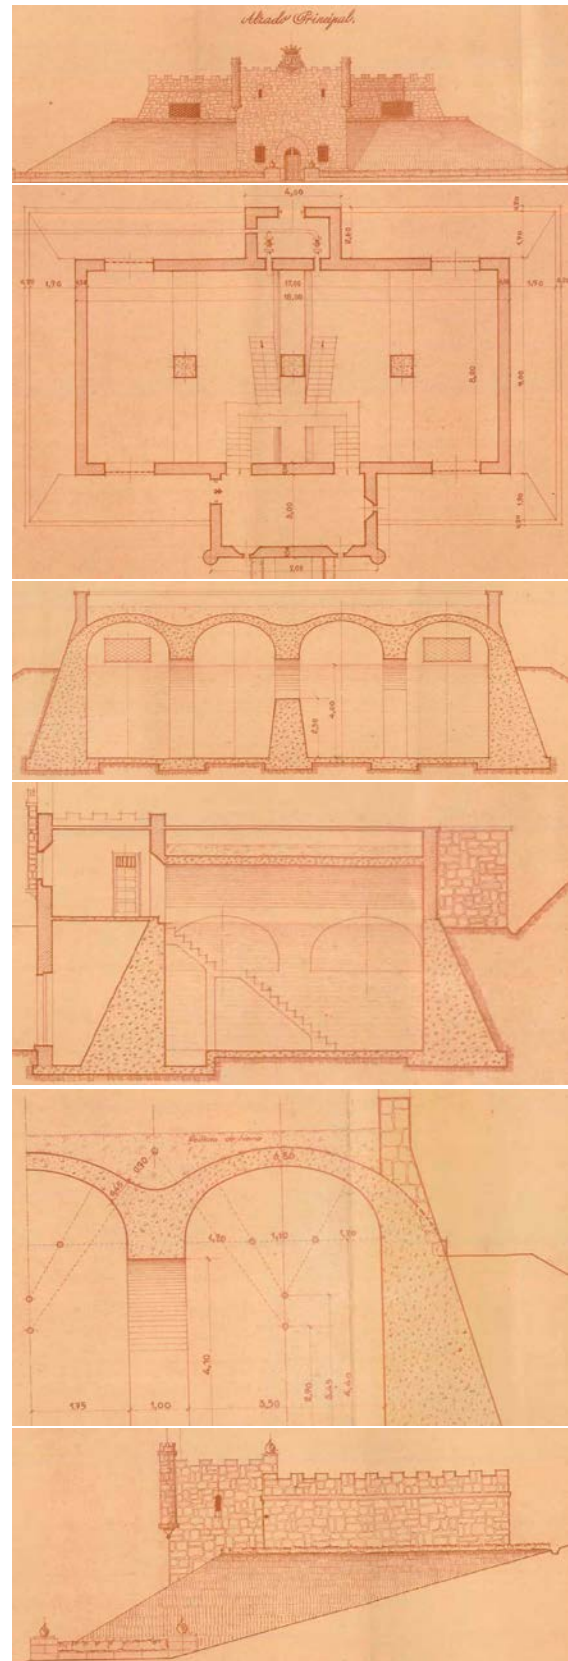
Conjunto de planos de Igeldo (AM)
